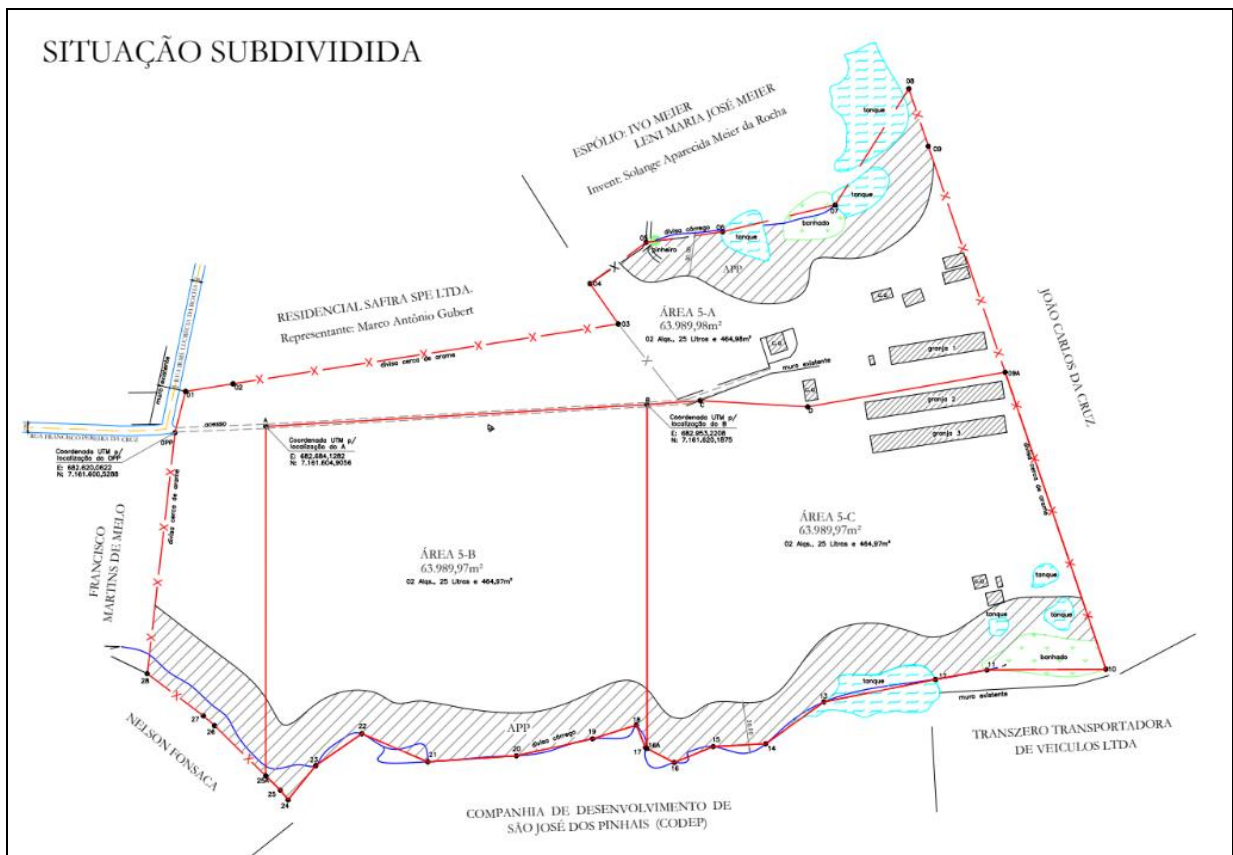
Planta de subdivisão da Área 5-B onde está implantado o Condomínio Residencial.
